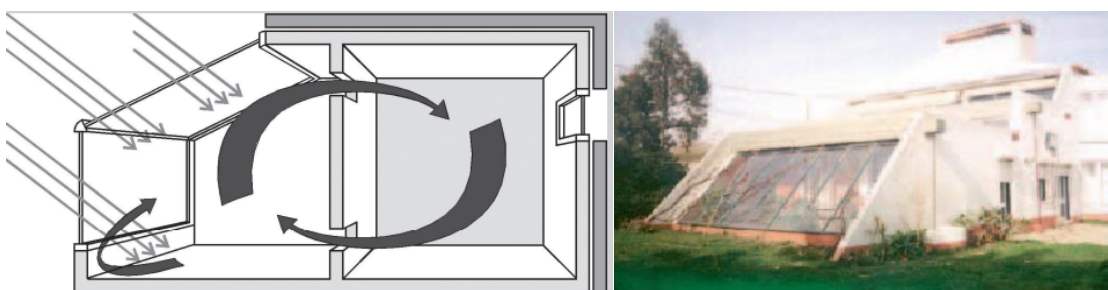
Sistema de aquecimento por ganhos isolados (em cima) e exemplo de habitação com estufa incorporada (em baixo) [56]
